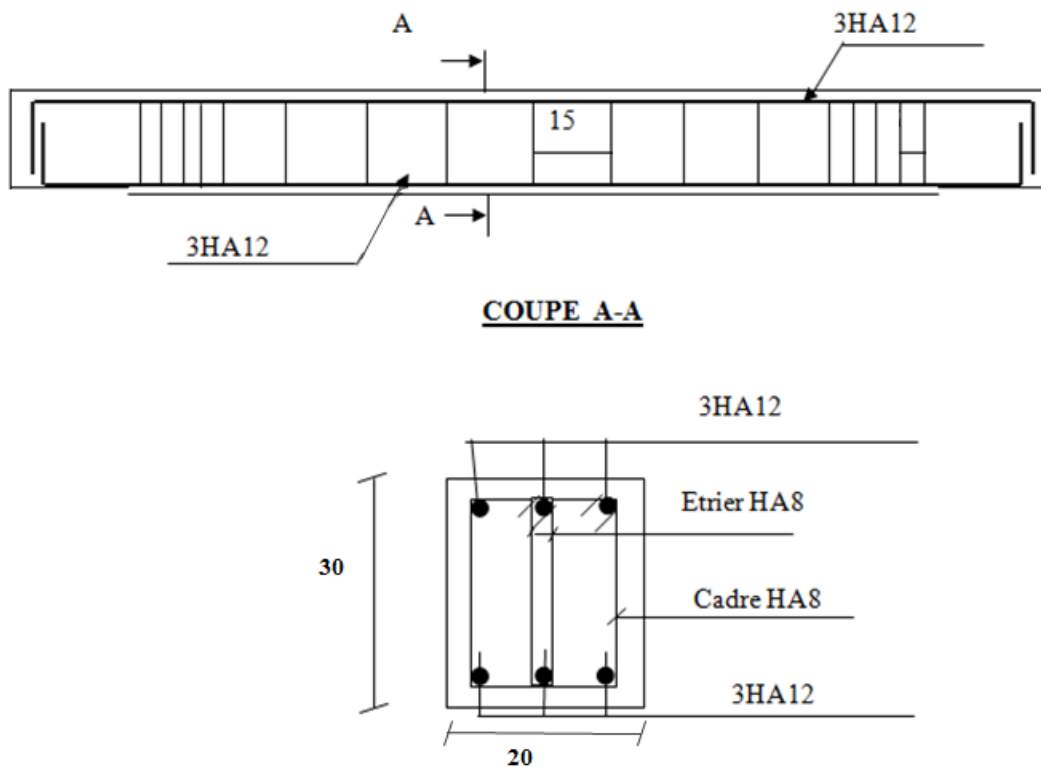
Schéma de ferrailage de la poutre de chaînage
